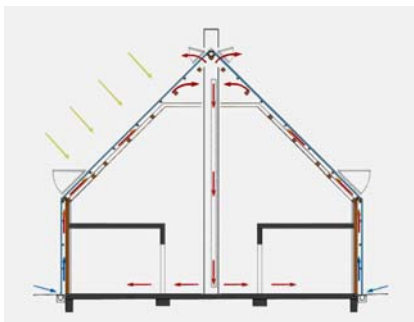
Schnitt durch das Patchworkhaus, Quelle: www.architektur.tu-darmstadt.de/powerhouse
